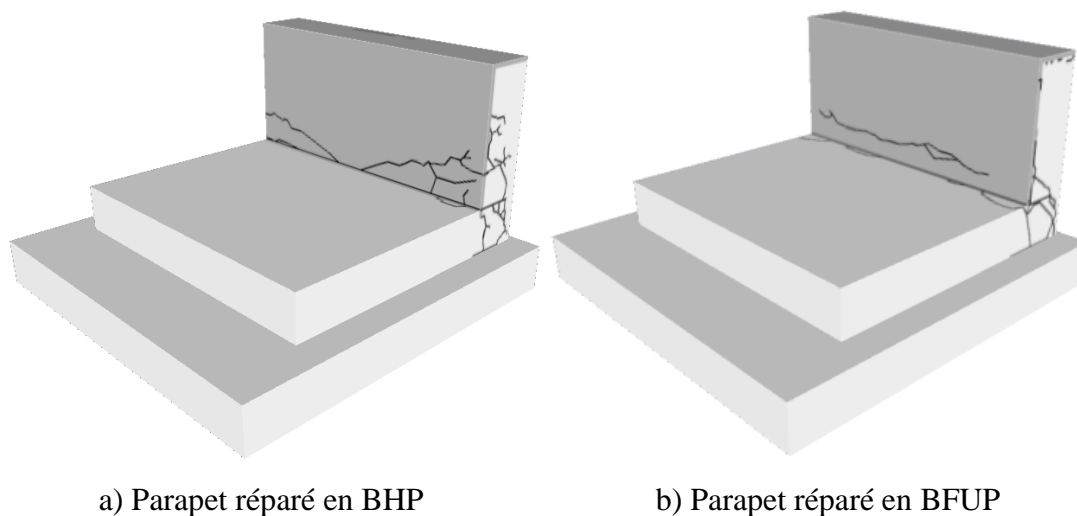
Patron de fissuration dans les parapets réparés à l'arrêt des essais mécaniques
